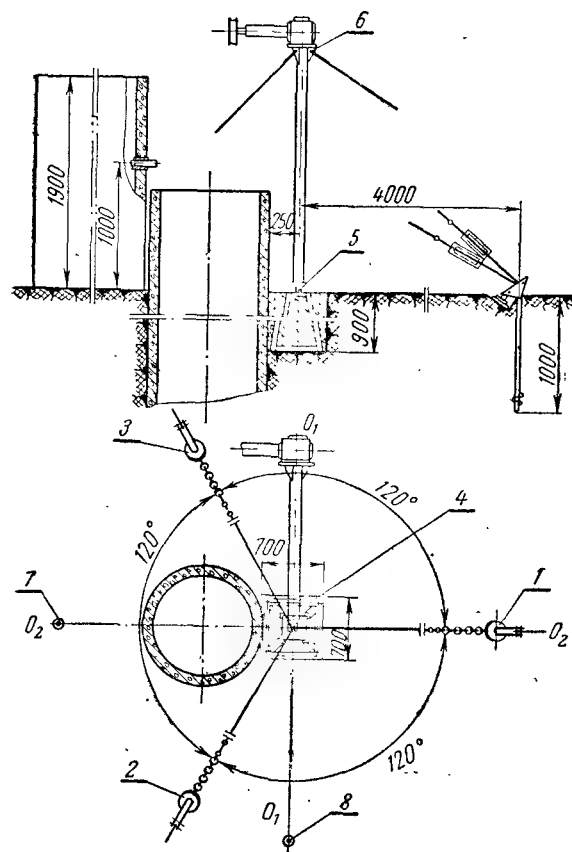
Схема разметки площадки для монтажа ветроустановки ВВУ-3:
